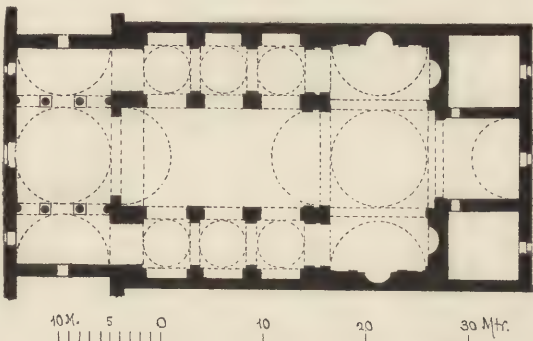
Annunziata zu Arezzo. Grundriss. (Gnauth.)
